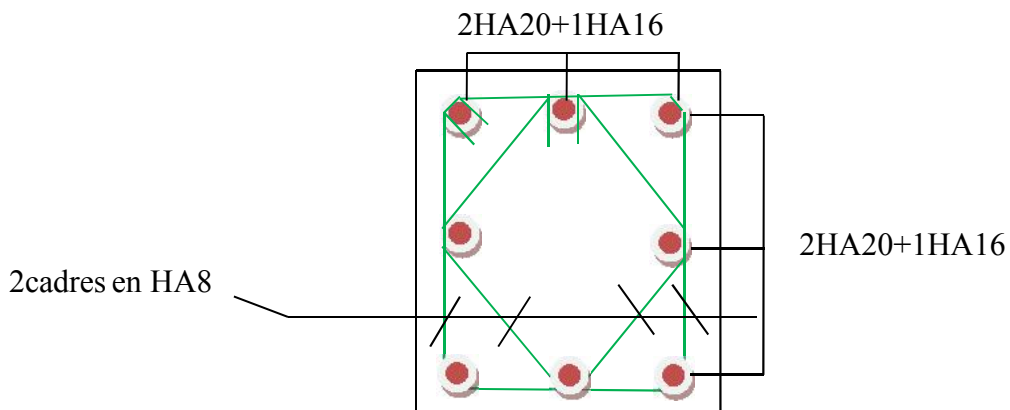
Coupe verticale sur poteau (50x50) et (45x45)cm²
